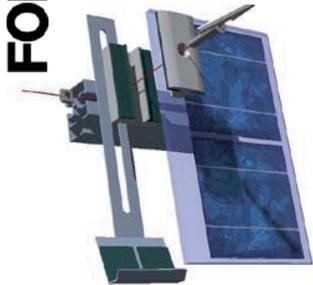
Konstruktionsdetail PV-Fassade: Klemmdetail mit Stützschiene. Foto: ATB-Becker
